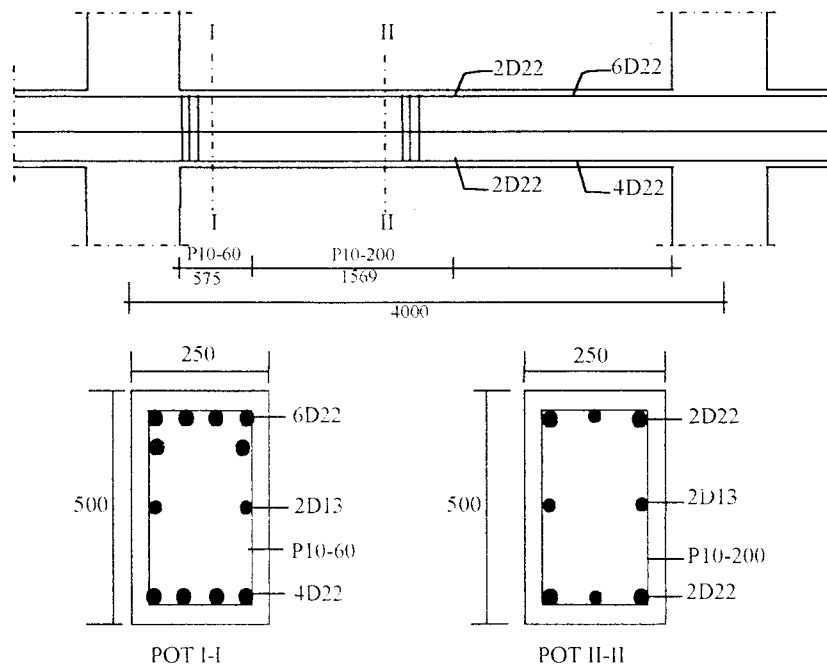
Balok Portal E Bentang 4 m Lantai 4
